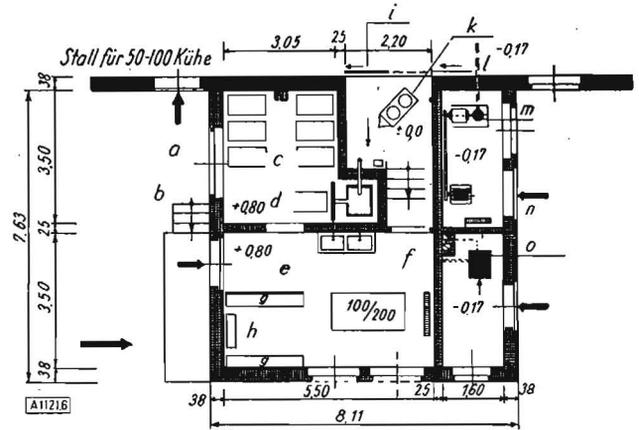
Melkanlage für 50 bis 100 Kühe mit Milchbehandlungsraum in Rampenhöhe. Anbau an einen vorhandenen Stall
